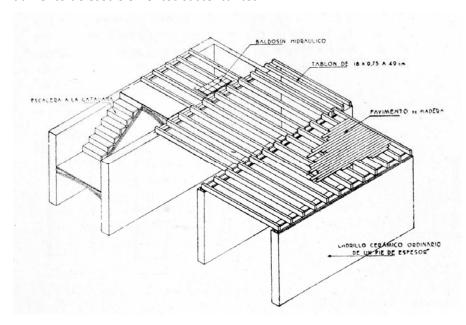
Sistema constructivo propuesto por Fisac para las Casas en cadena.
